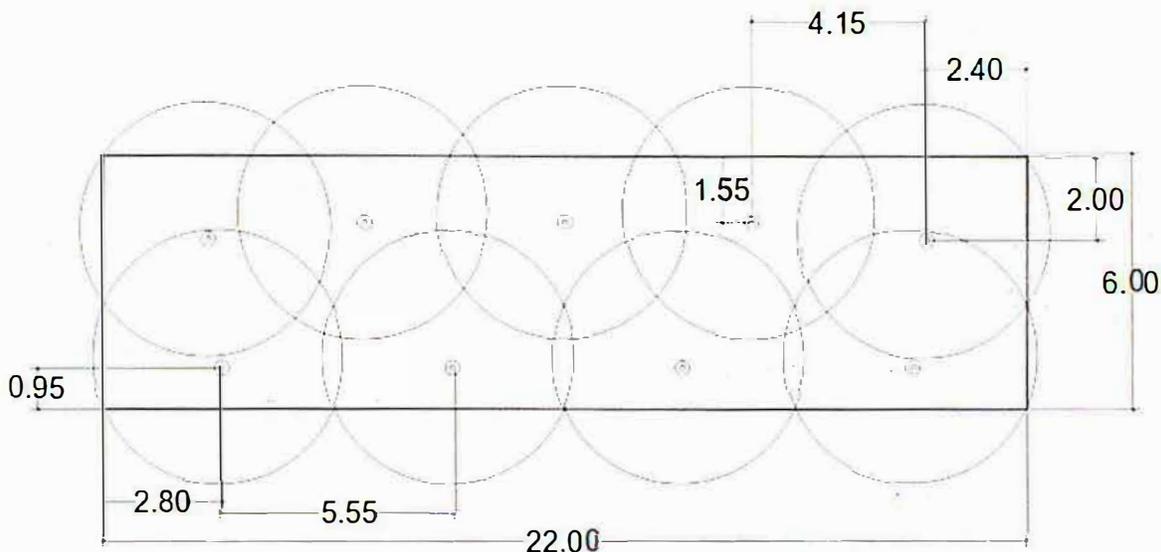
Vista de planta, distribución de los pozos para airear el área impactada A-1.
